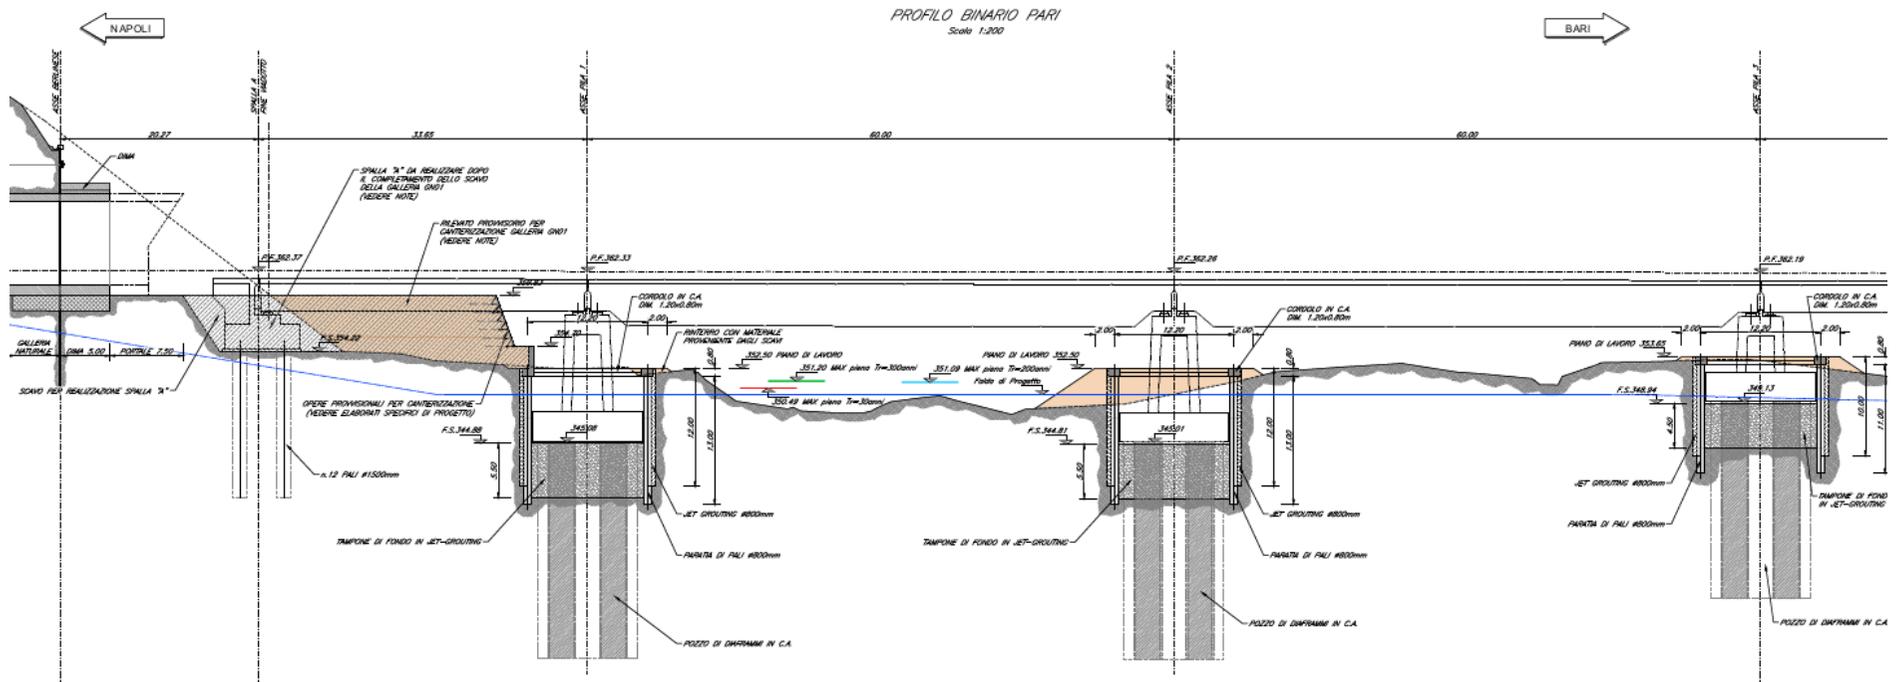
Spalla A, Pila 1, Pila 2 – Opere provvisionali - Profilo longitudinale
